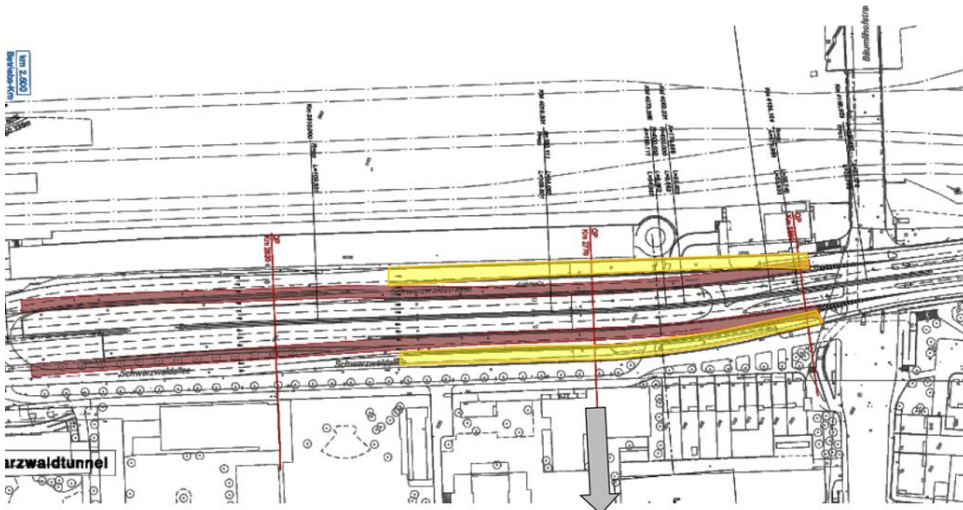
Verschlingungen auf Seite Kleinbasel zwischen der Riehenstrasse und der Wettsteinallee (gelb: Rückbau altes Rampenbauwerk, rot: Neubau Rampenauffahrt)
